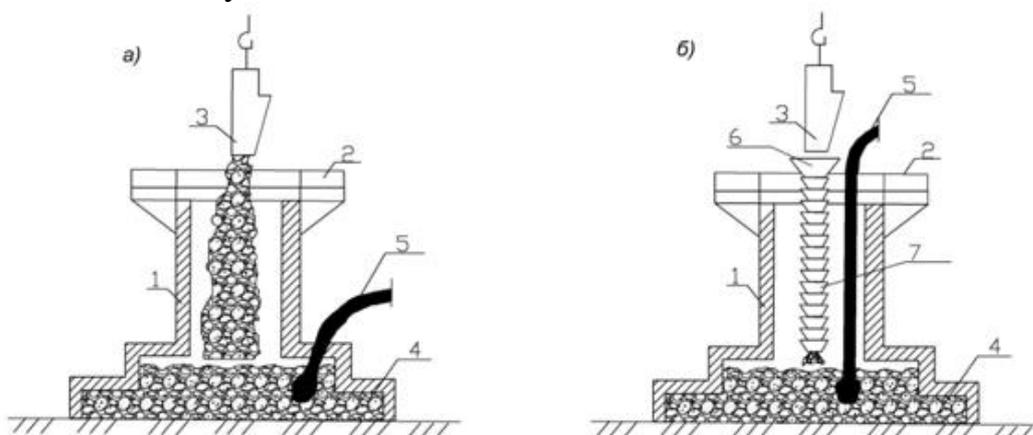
Схема бетонирования монолитных ленточных фундаментов:
